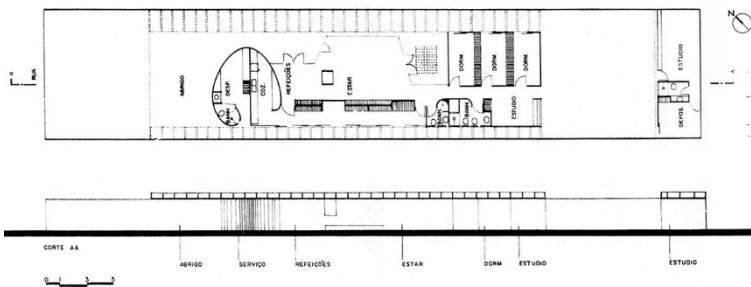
Casa Chyio Hama. Situação planta e corte.
